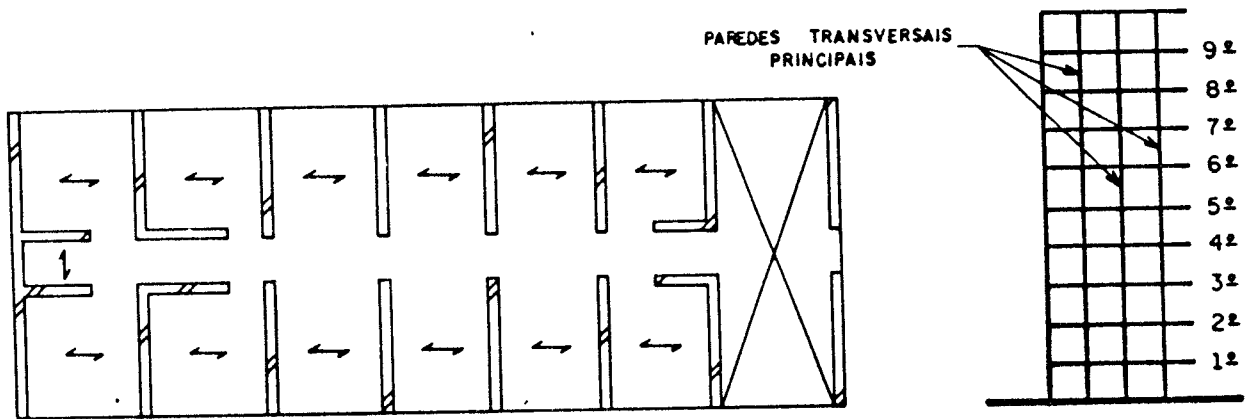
Edifício com 9 pavimentos no sistema de paredes transversais (Fonte: CURTIN et alii [9]).
